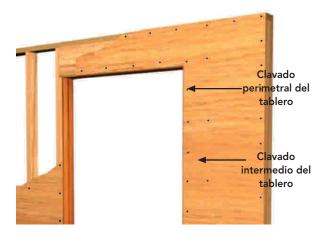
34: Tablero fijado sobre entramado vertical y distribución de las fijaciones.
